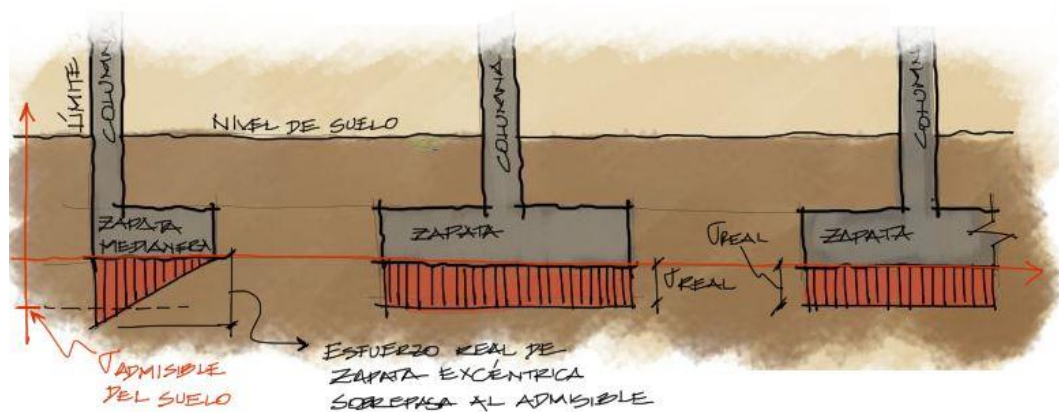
Esfuerzos en un sistema aporticado con zapatas aisladas
